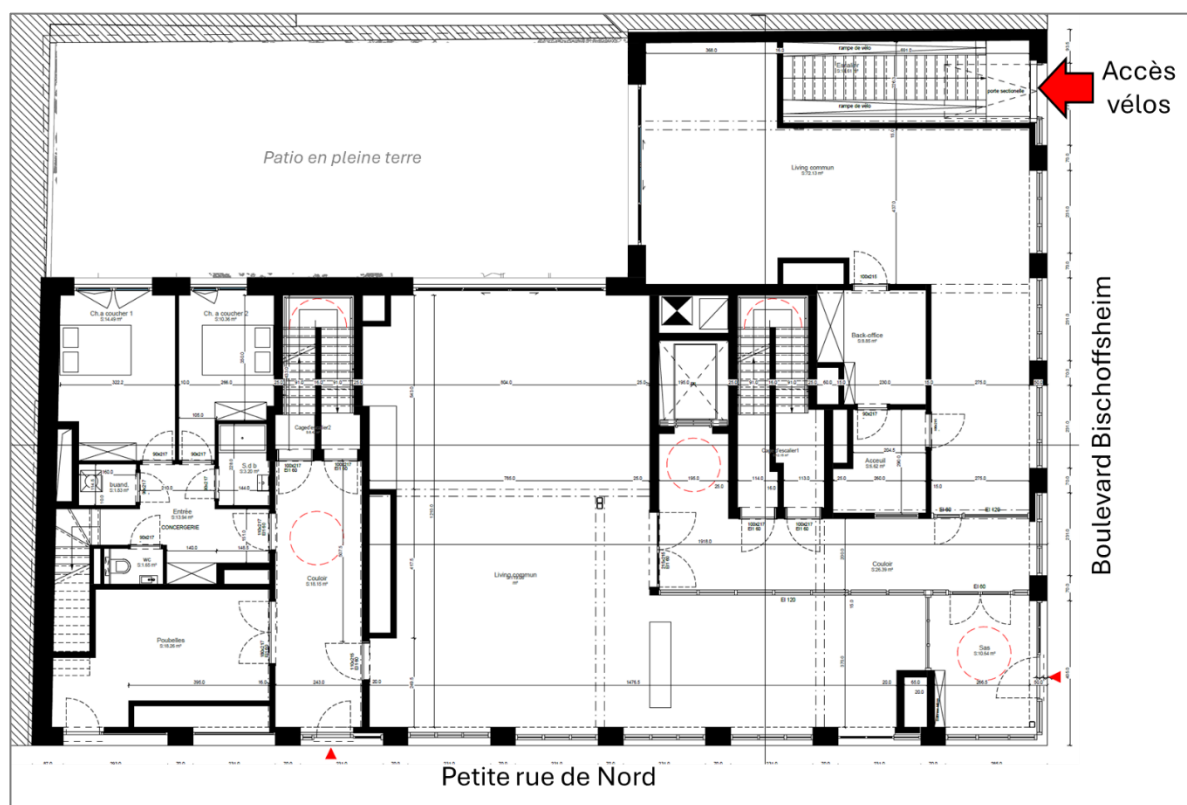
Accès au local vélo – R+0 (source du fond de plan : B2Ai)
